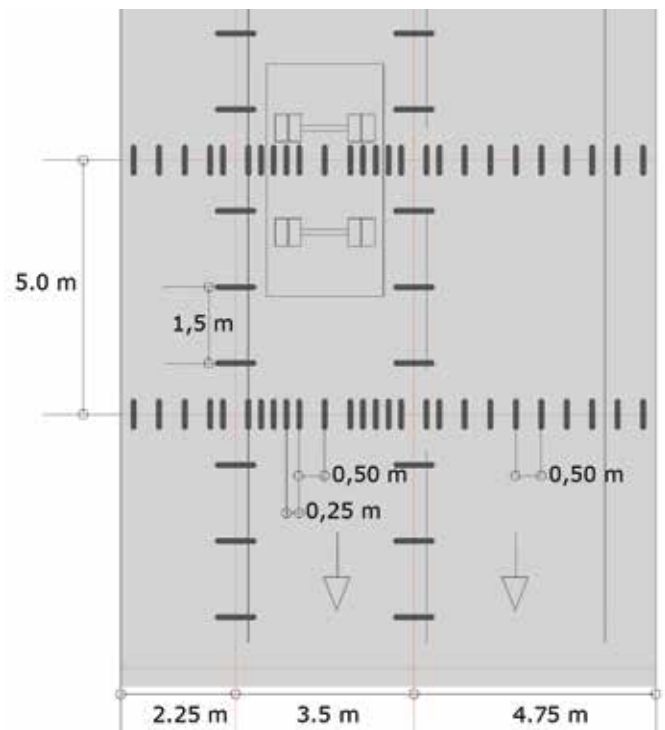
Planta de distribución de pasadores, barras de atado y juntas
